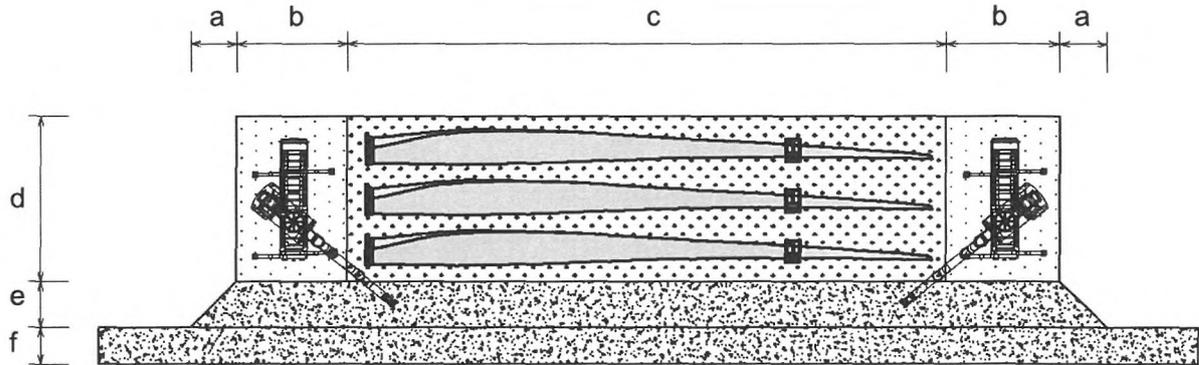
Rotorblattlagerfläche (Konstruktionsschema)
